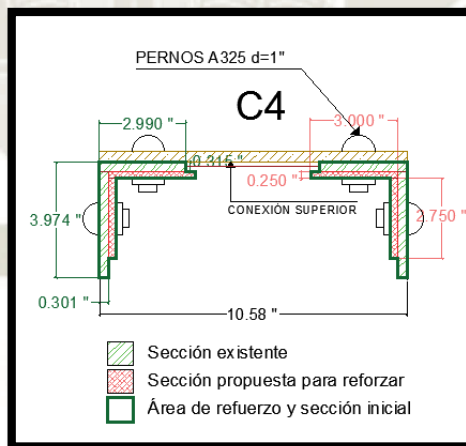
Sección de perfil real más perfil de reforzamiento de C4 – Compuesta. Arriostre
